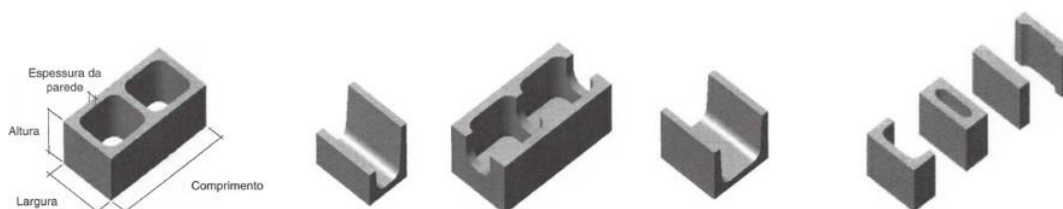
Bloco vazado de concreto simples, tipo canaleta e compensador.
